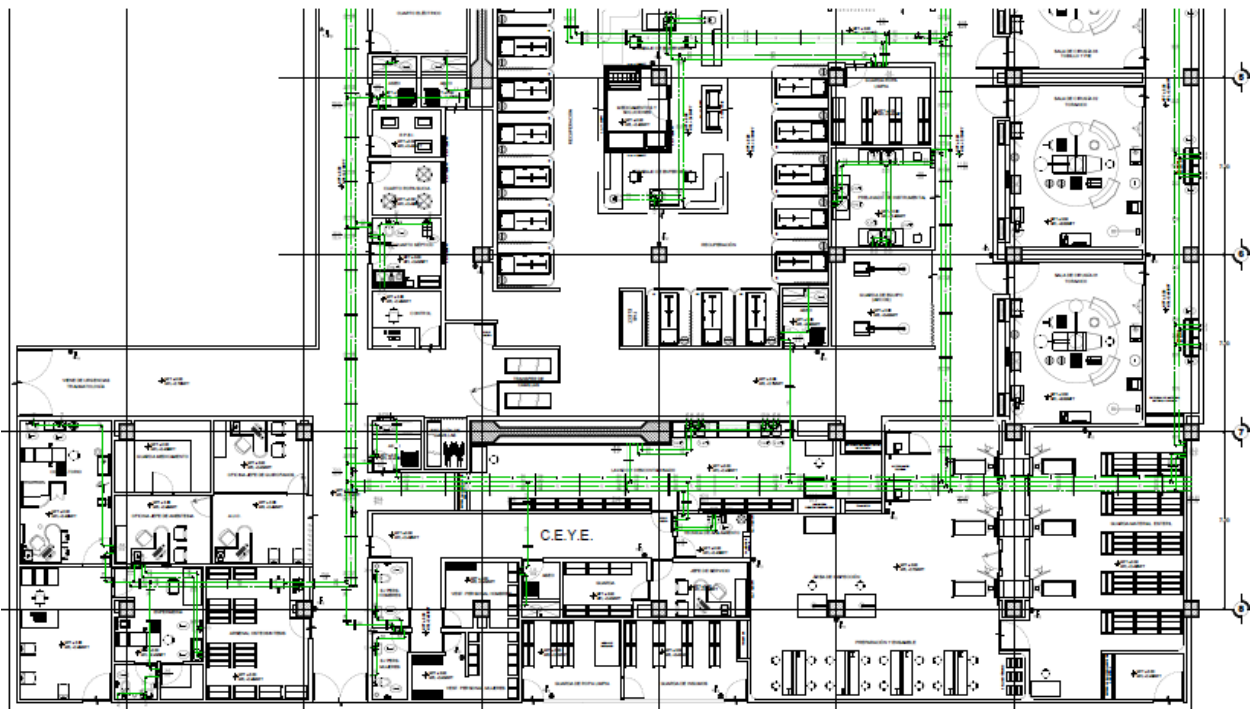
Extracto de plano de ingeniería hidráulica, se muestra la instalación diseñada (verde).
